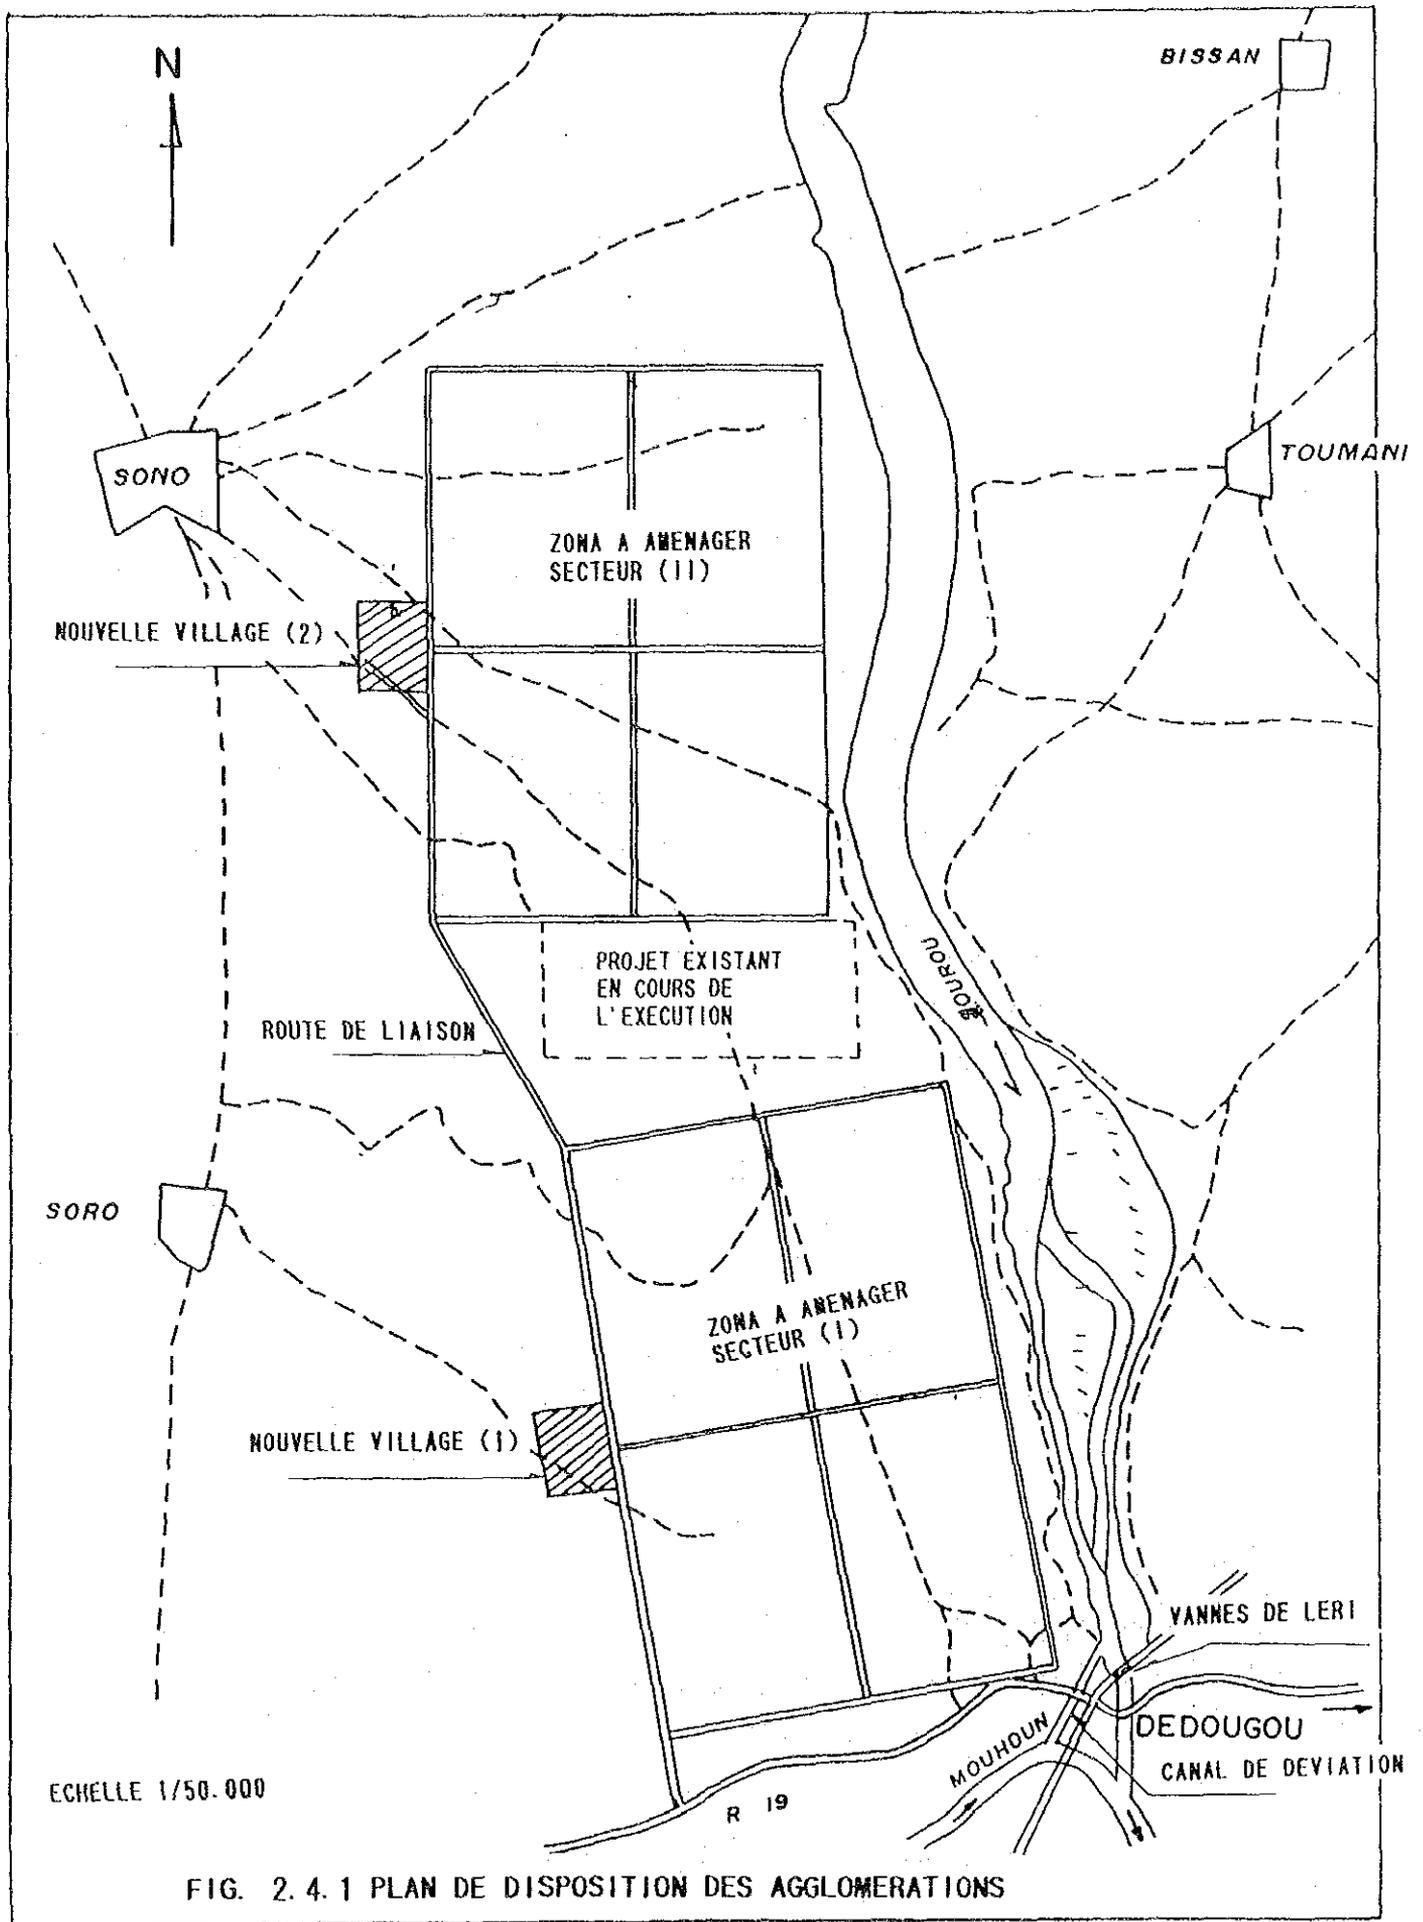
4. 1 PLAN DE DISPOSITION DES AGGLOMERATIONS
